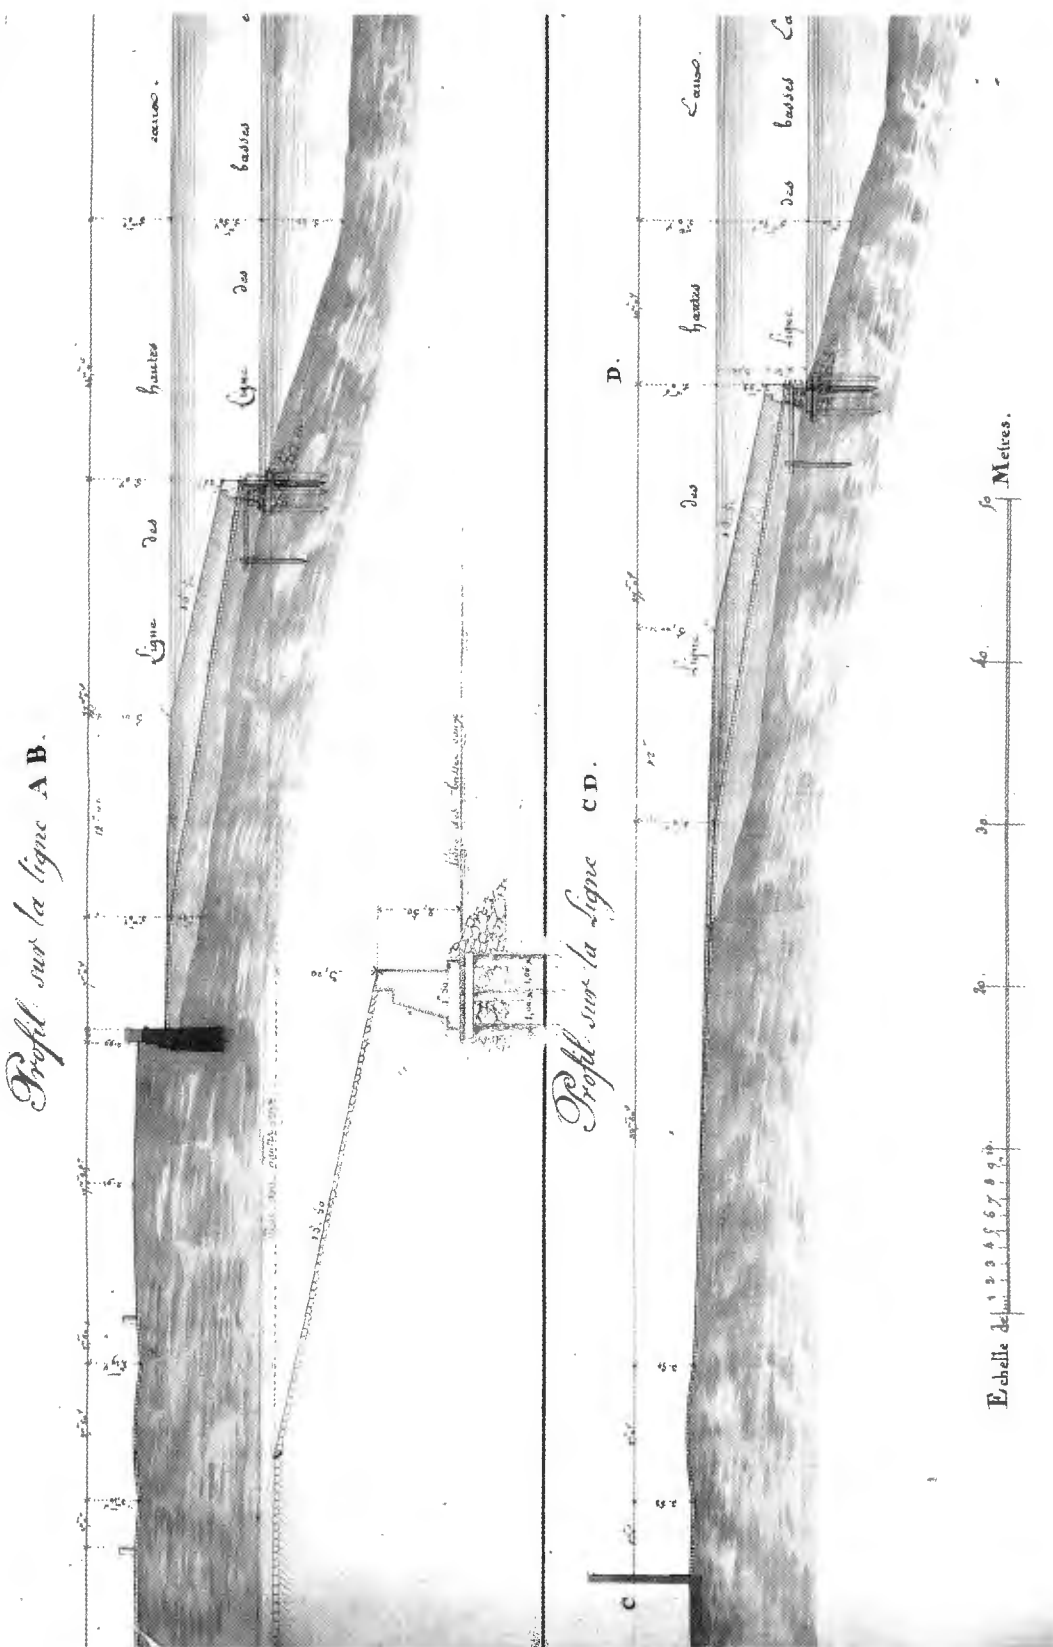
Coupes de la place Royale en 1819, établis pour un projet de construction d'un quai (A. D. Gir. C4500).
